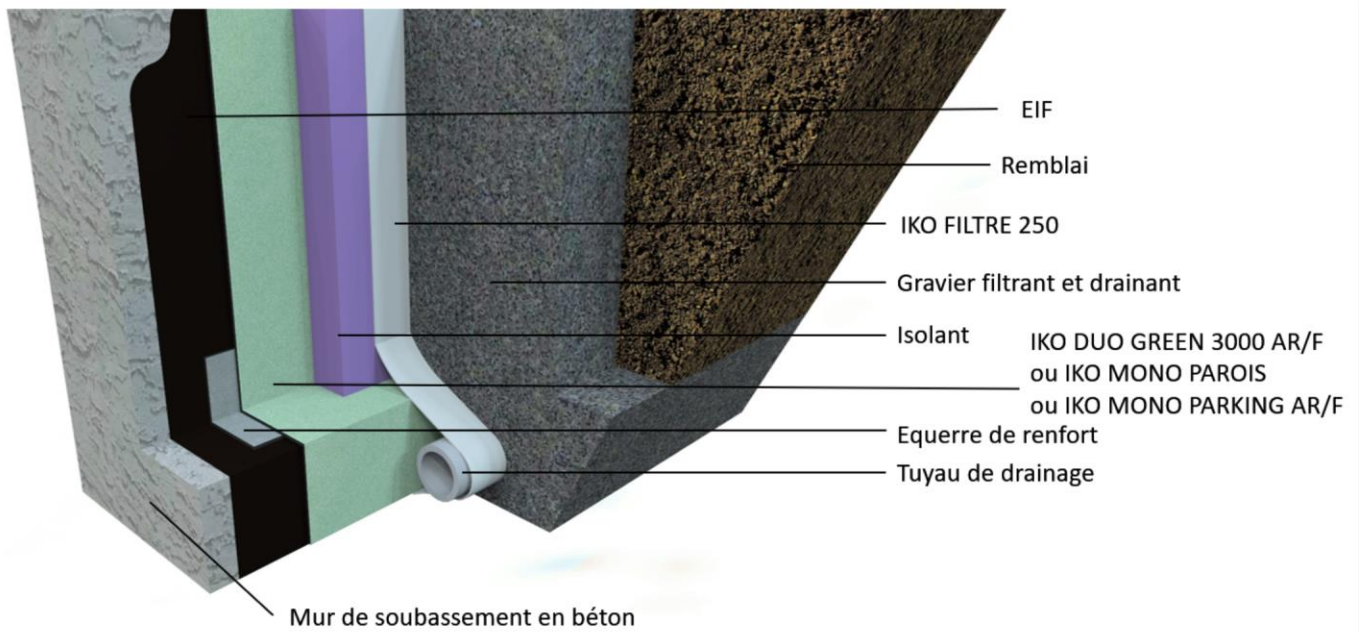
Paroi isolée (cas de l'isolant en appui sur la semelle)
